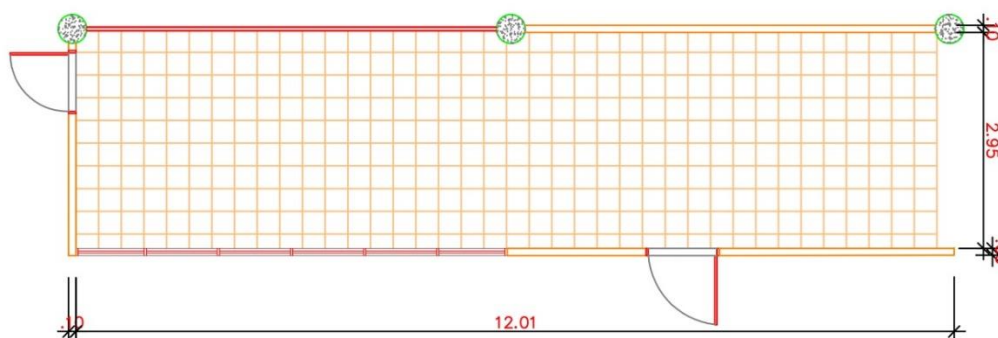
Corte de planta baixa sem mobiliário - Cenário 2.
